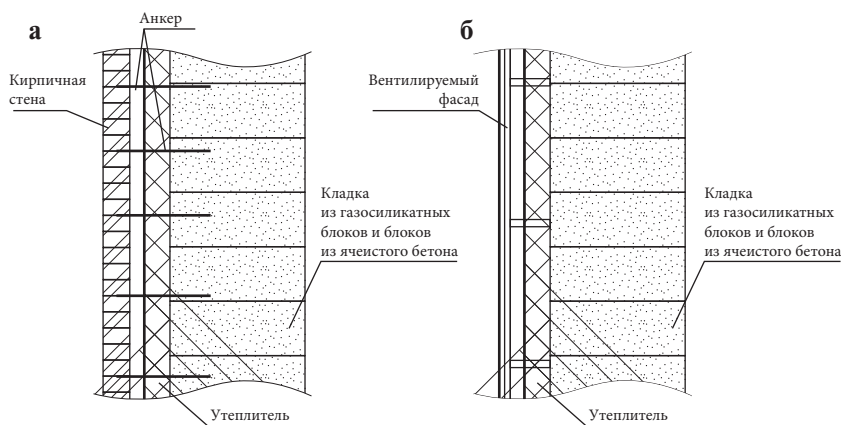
Наружная стена из газосиликатных блоков и блоков из ячеистого бетона: а) самонесущая стена; б) навесная стена
